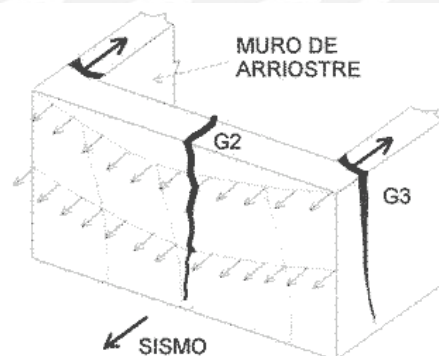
Grietas verticales debidas a fuerzas fuera del plano (Fuente: CERESIS)
